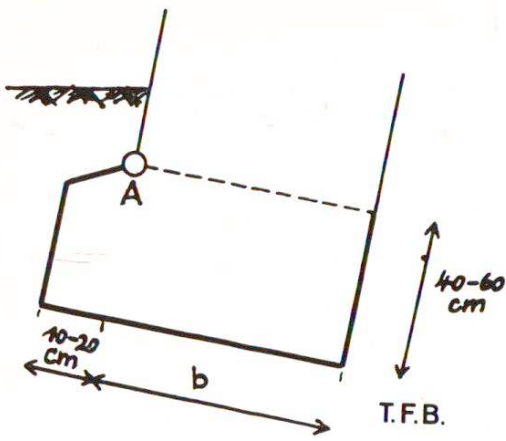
Dimensions de la fondation d'un petit mur de soutènement
